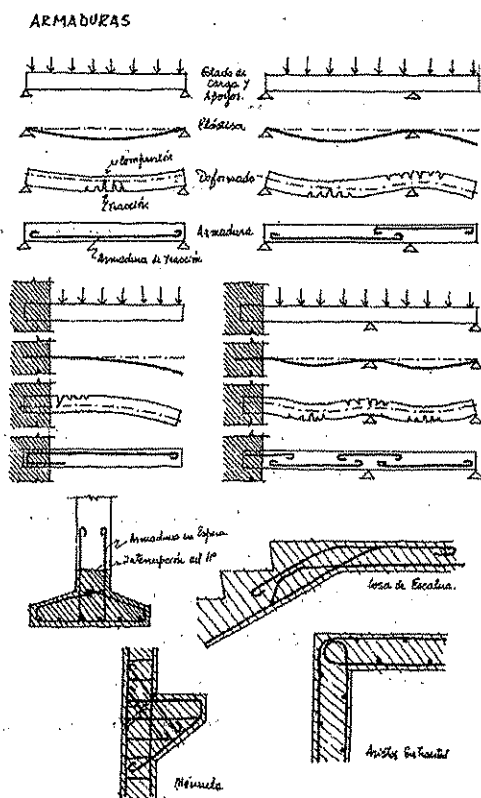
Tipos de apoyo, deformaciones y armaduras
